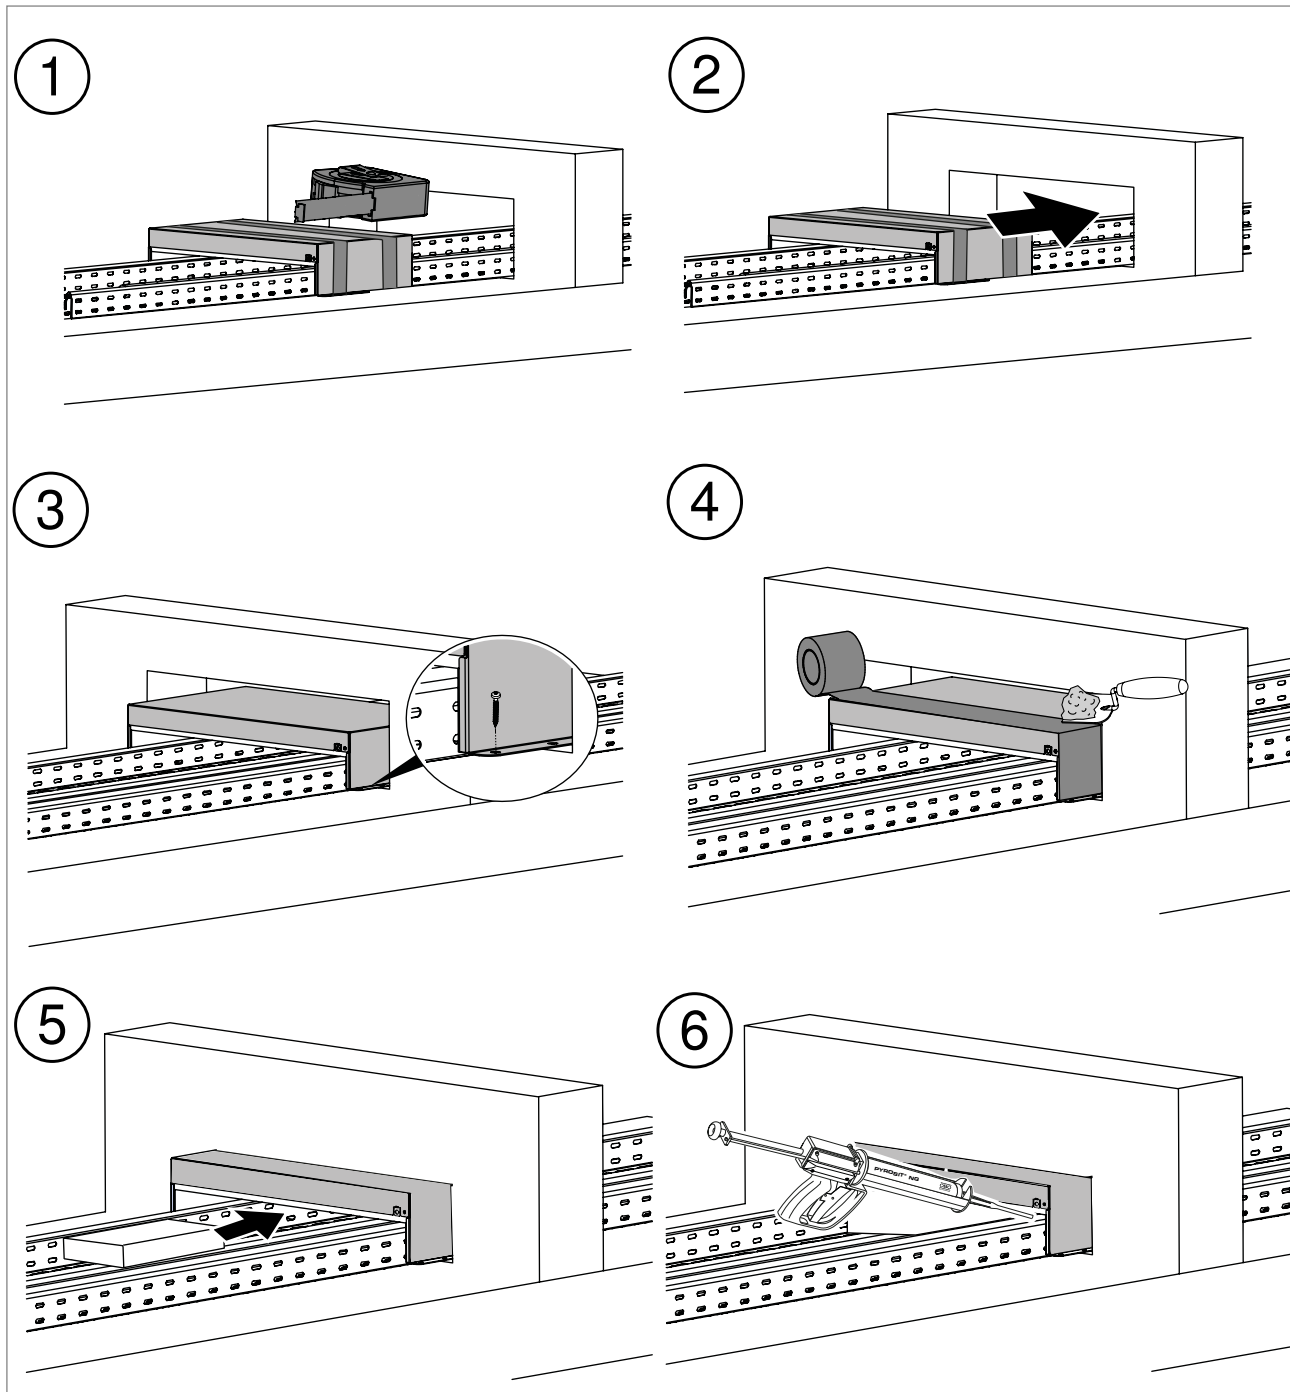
Mounting the 3-sided PYROPLUG® MagicBox (wall mounting)
